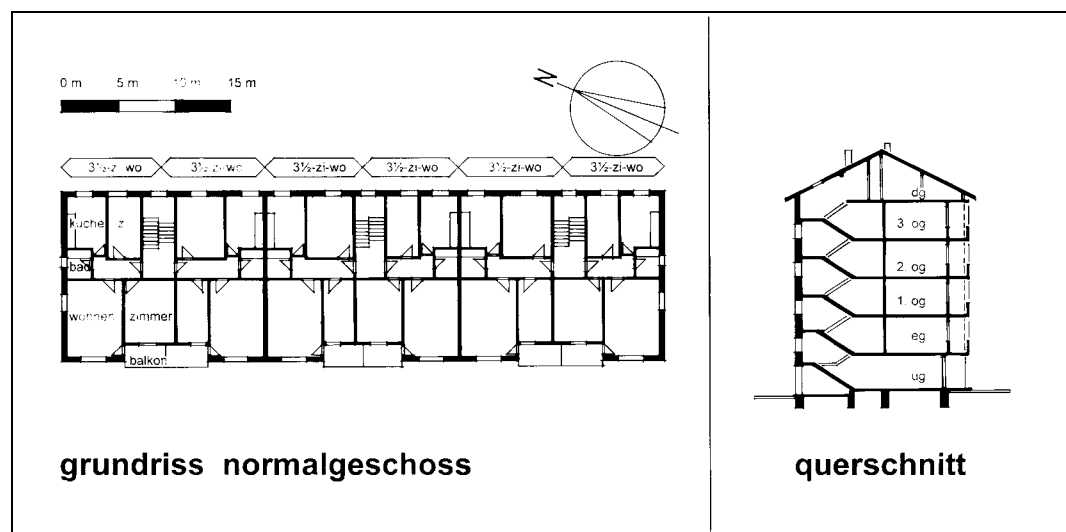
Grundriss Normalgeschoss und Querschnitt von Objekt 1.
